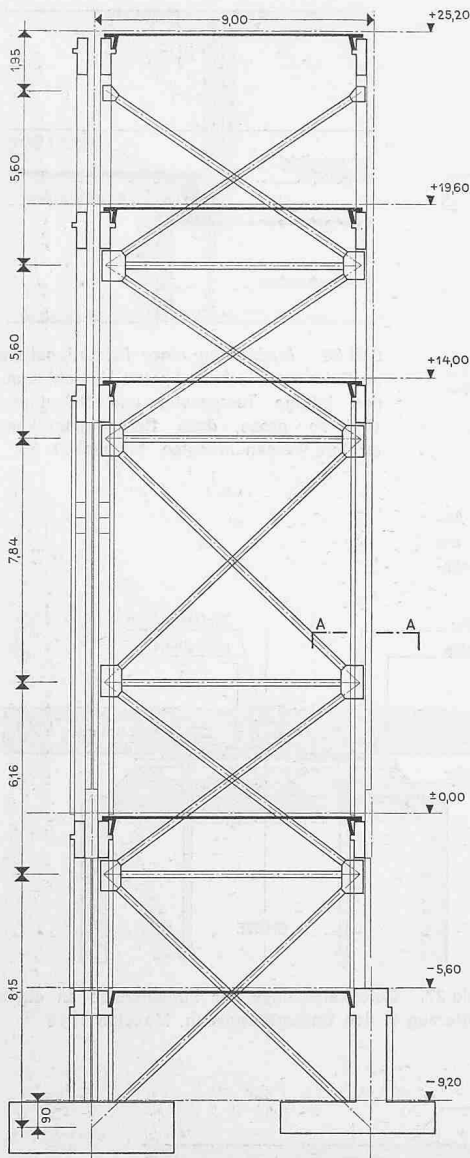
Stabilitätsverband zwischen den Axen 12 und 13 zur Aufnahme der Windkräfte im Montagezustand. Durch HV-Schrauben werden die Knotenbleche an die Betonelemente gepresst, wodurch ein Anschluss auf «Reibung» erzielt wird. Damit konnten die auftretenden Toleranzen ausgeglichen werden. Masstab 1:250
